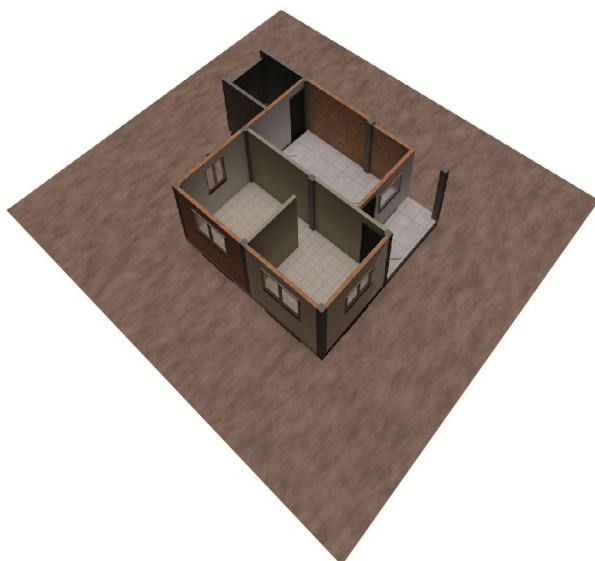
Planta arquitectónica de la propuesta de rediseño arquitectónico
